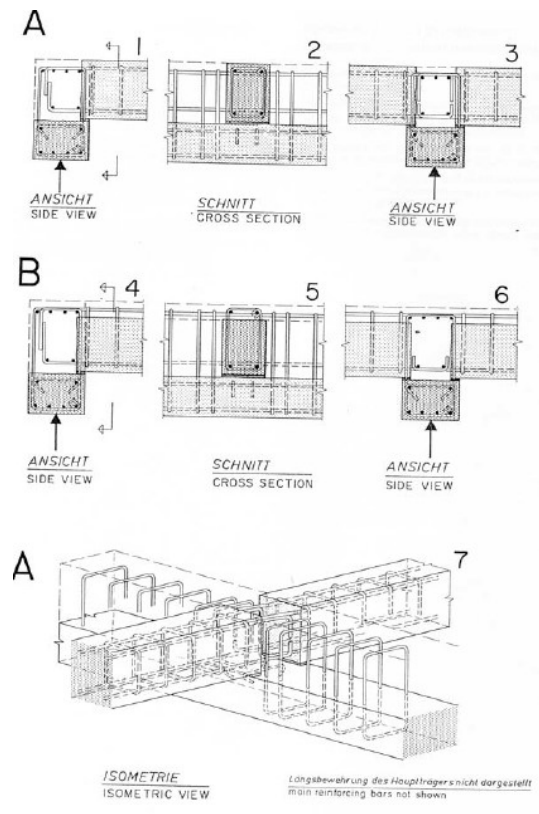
Ligação por betonagem *in situ* do nó (Stupré, 1981)
